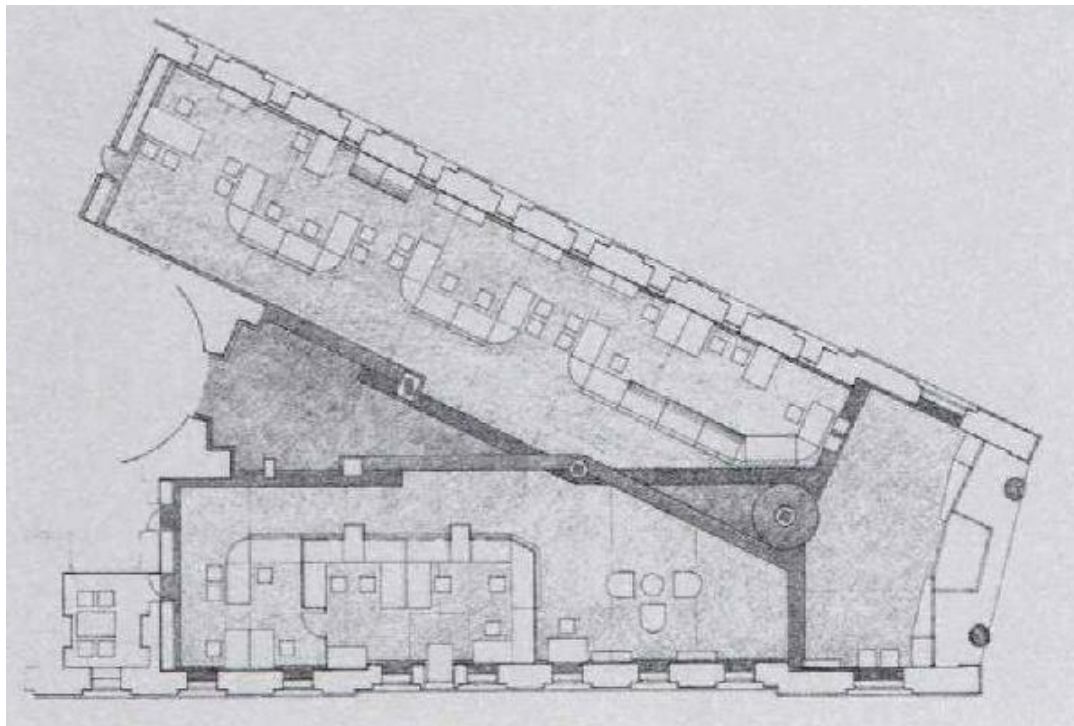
Grundriss mit Möblierung, Radetzkyplatz, Luigi Blau, 1984
